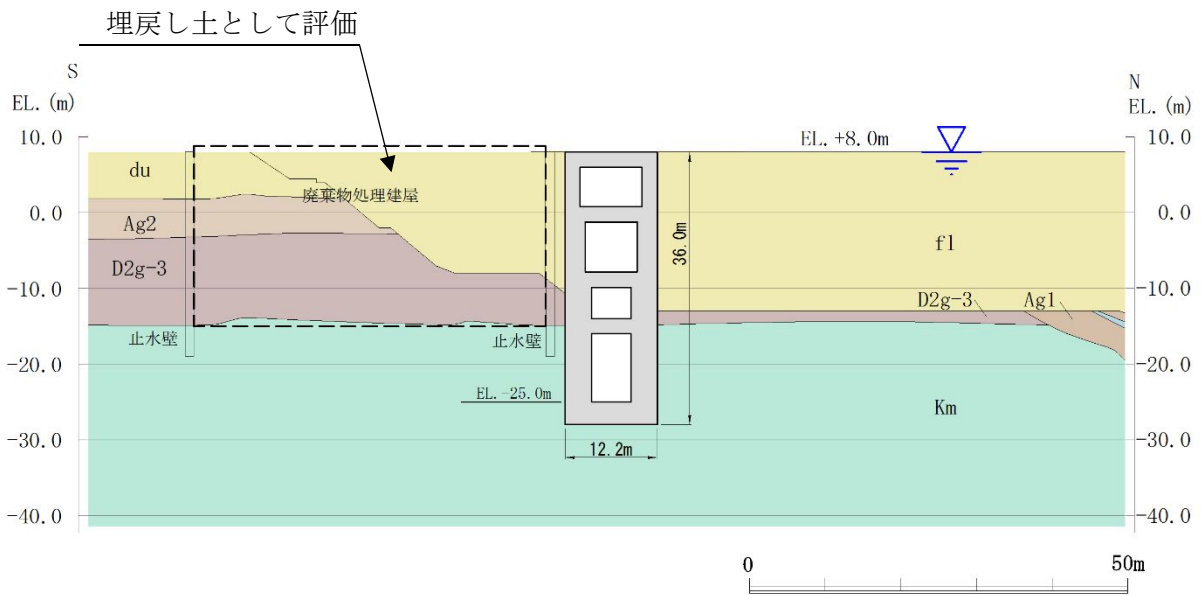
(3) 地質断面図 (南北方向 B-B断面)
